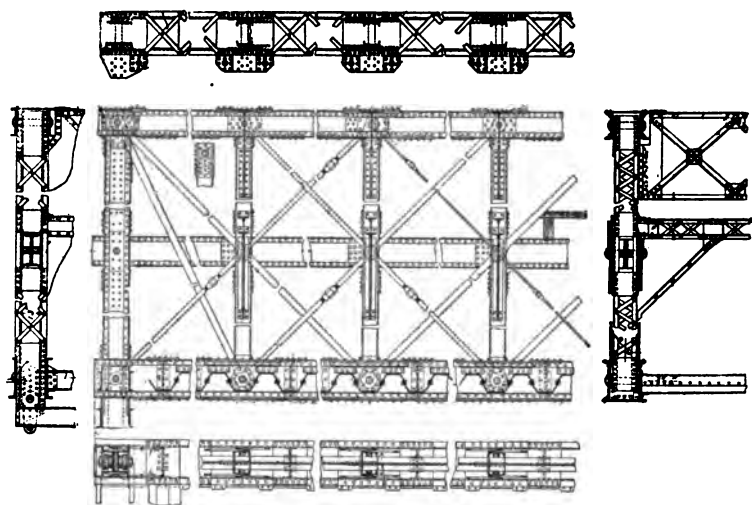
Détails du pont-tournant sur la Willamette (Rail Road Gazette).
